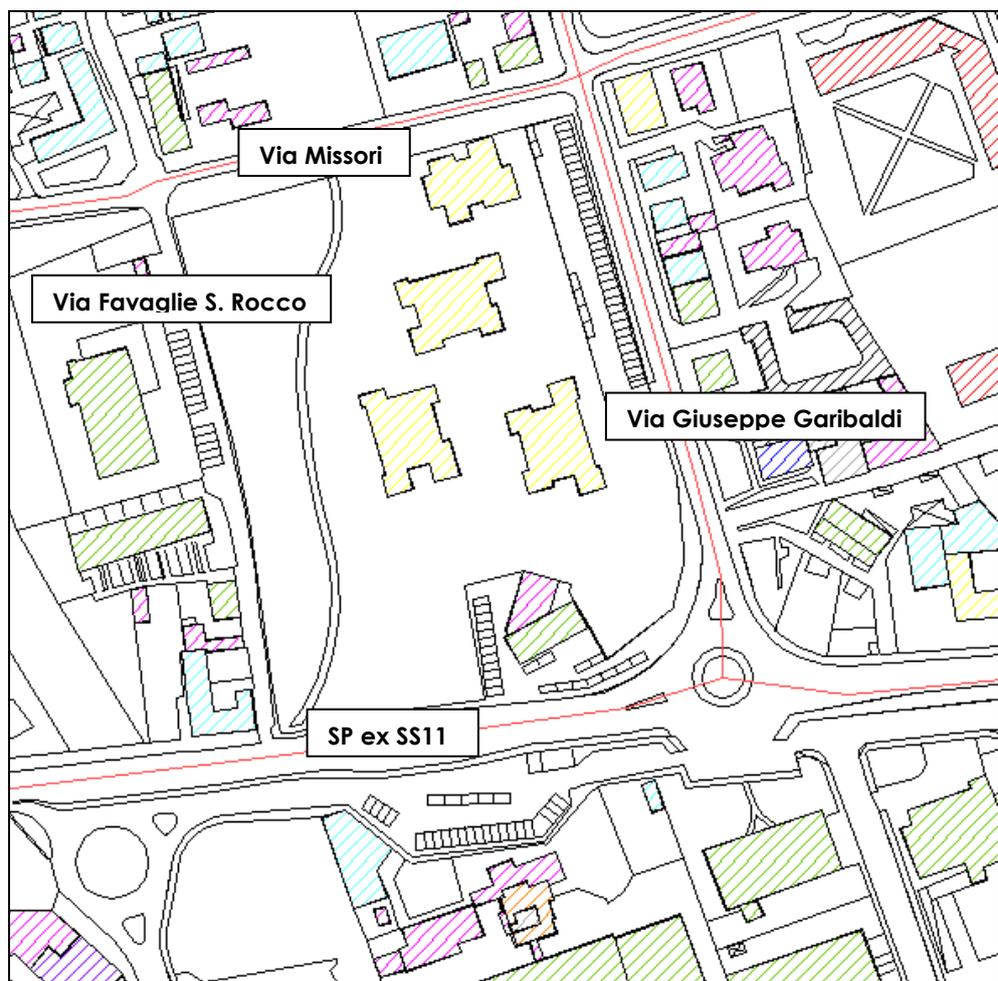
Planimetria con indicazione dell'altezza degli edifici allo stato di progetto
